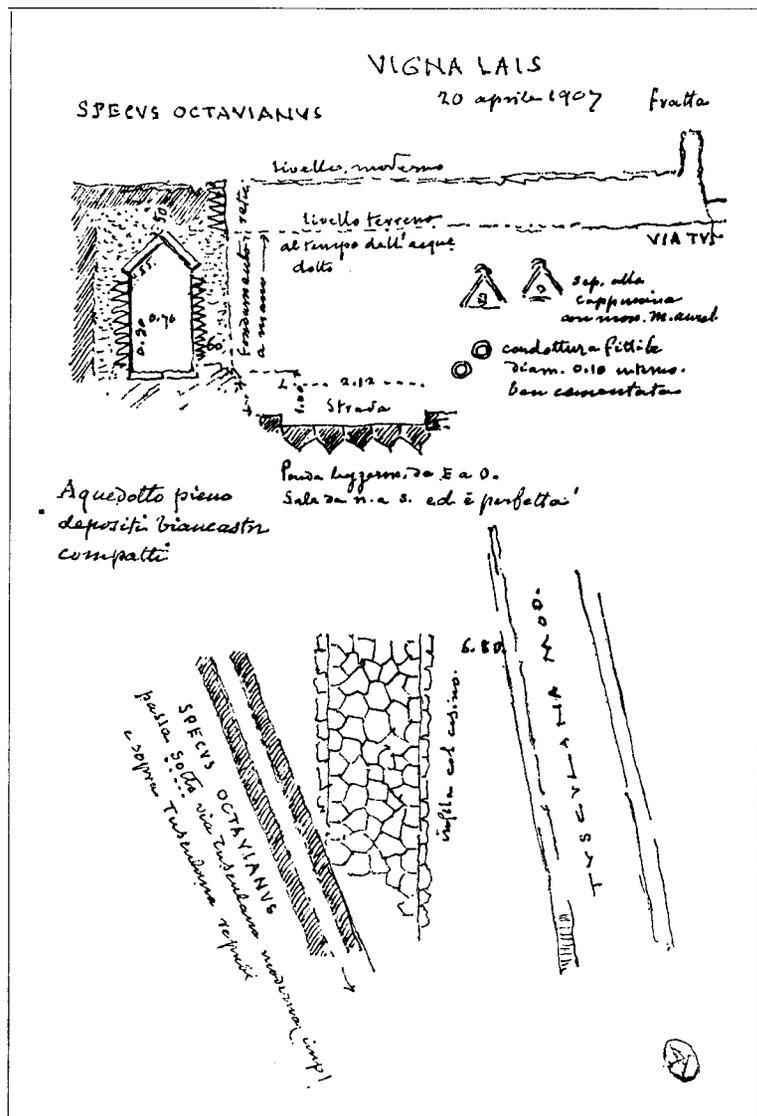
Pianta e sezione della via e dell'acquedotto al km. 2,5 della Tuscolana. (disegno di Lanciani)
